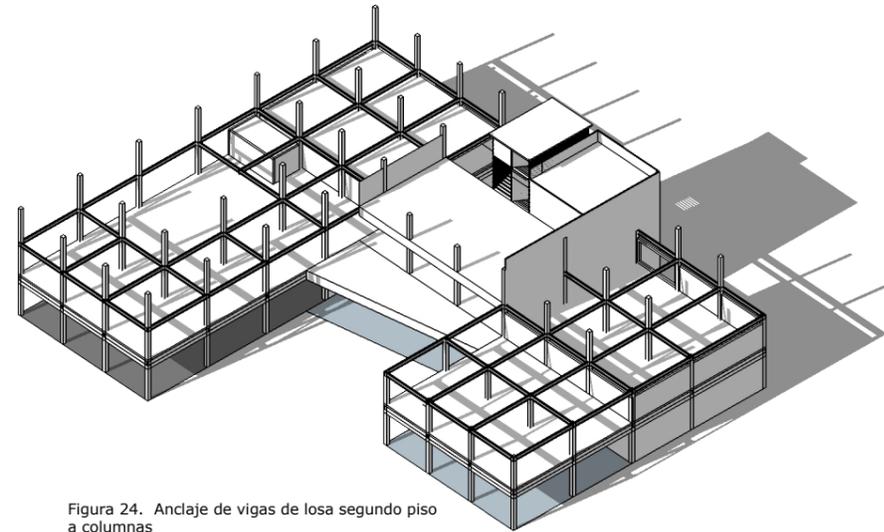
Anclaje de vigas de losa segundo piso a columnas
